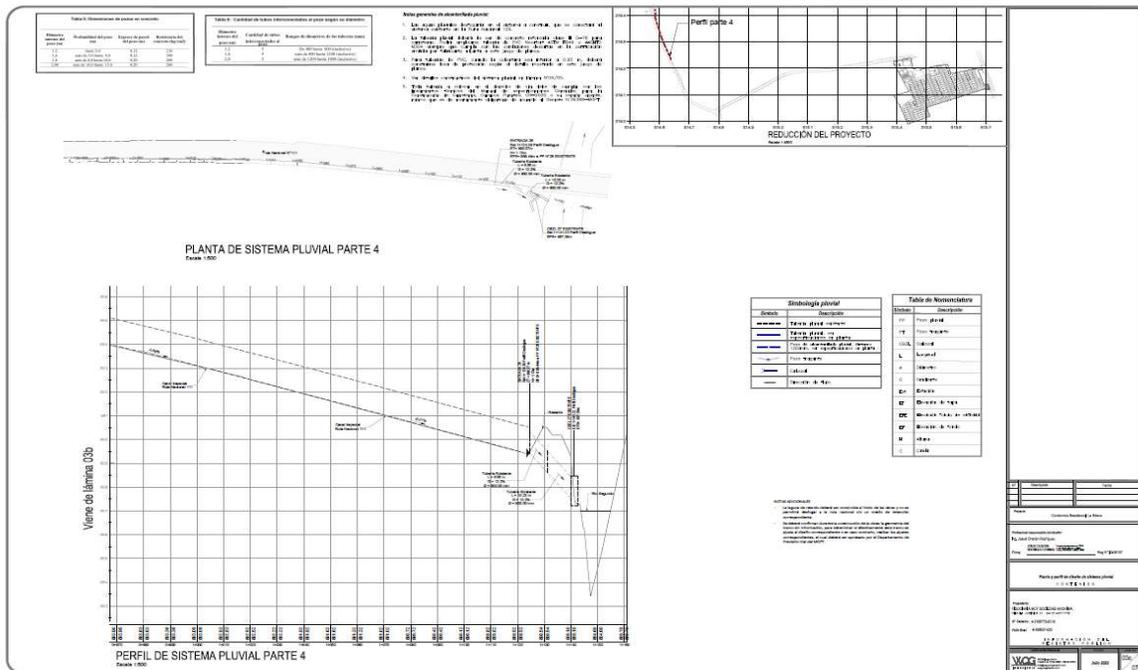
Trayecto de Tubería Pluvial sobre Ruta Nacional # 129, descarga en Río Segundo. (trayecto # IV). Lámina Pluvial # 03d
